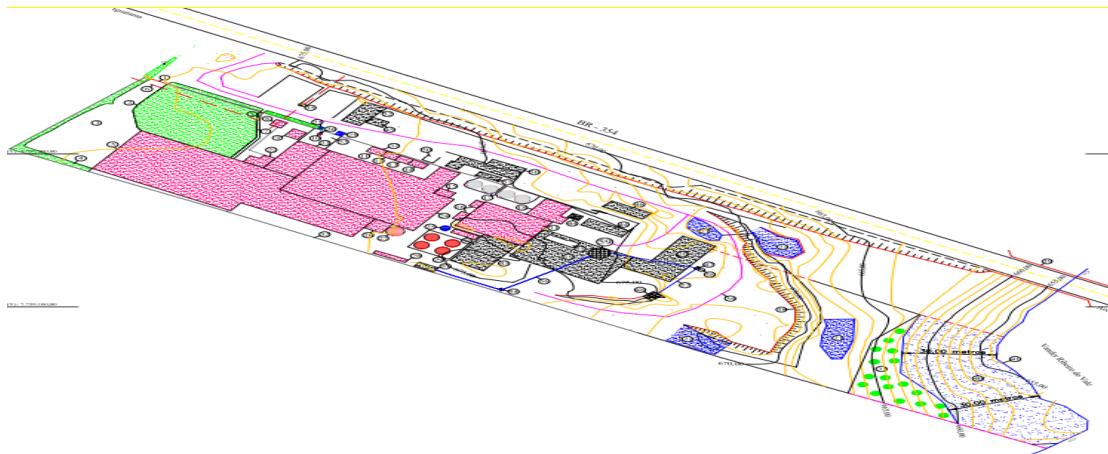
Planta topográfica do empreendimento Fonte: Estudo de LAS
